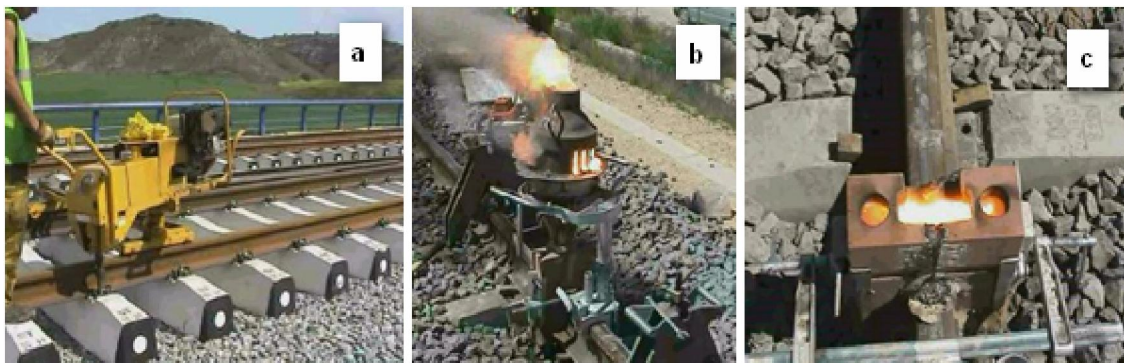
a) Motoclavadora hidràulica per realitzar l'apretat de les subjeccions. b) Crisol de la soldadura aluminotèrmica. c) Motlle de la soldadura, extret de [9].
